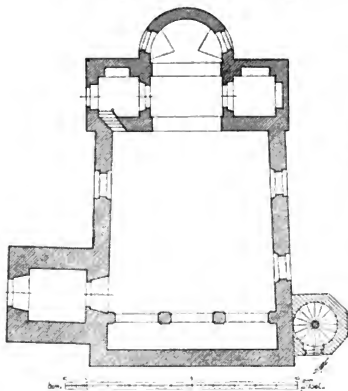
Suchdol. Grundriss der Kirche.
